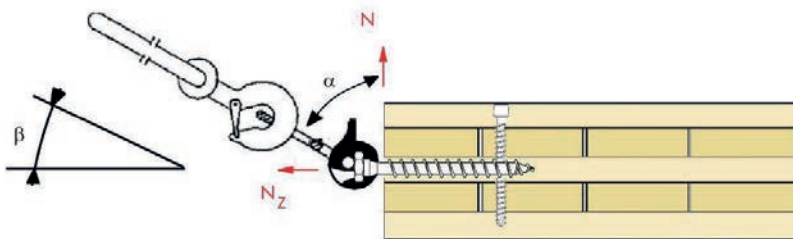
Querkzugverstärkung mit ASSY plus VG Vollgewindeschrauben bei Schrägzug
